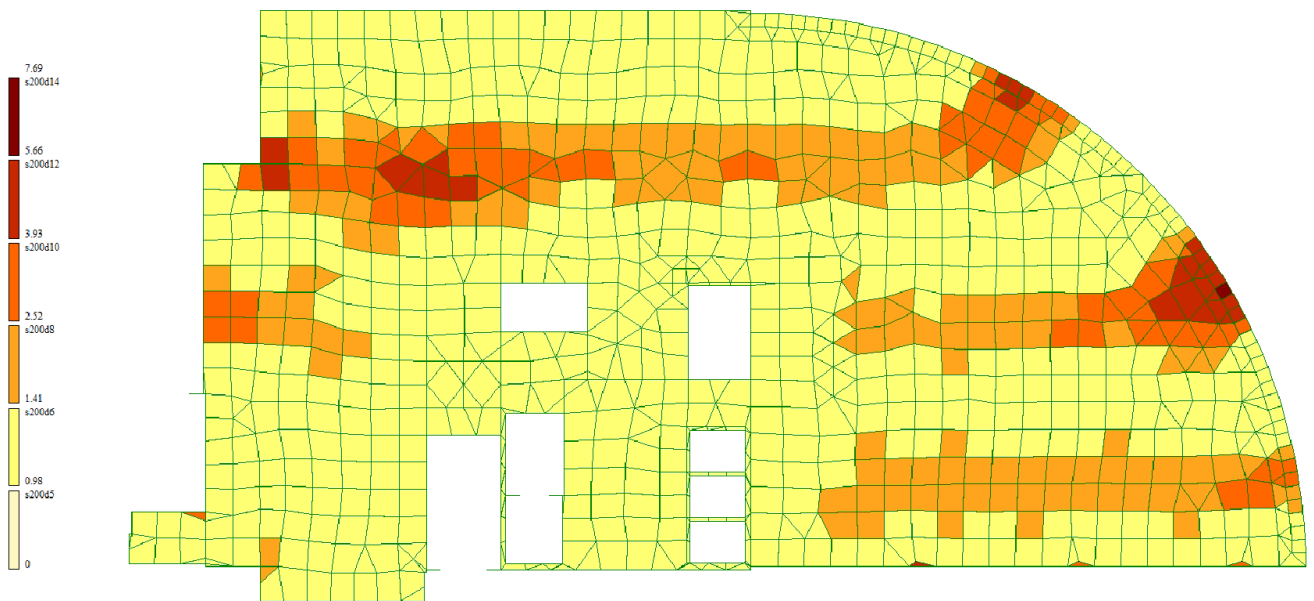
Армування перекриття над першим поверхом (нижнє Y)
